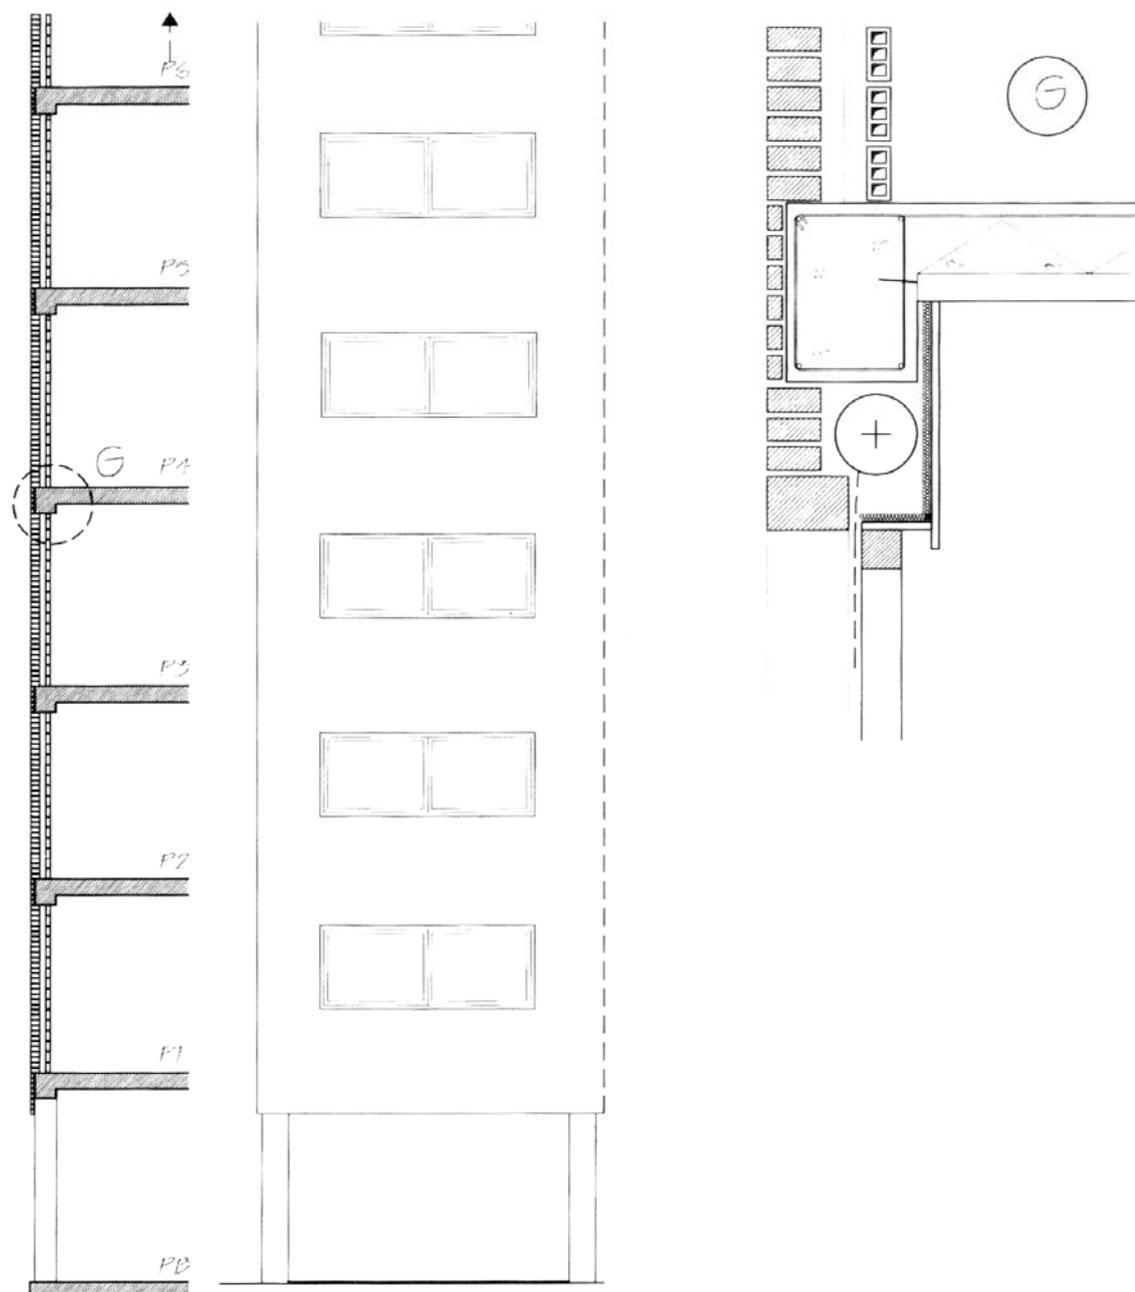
Años 70: Estructura de hormigón. Hoja exterior semivolada de ½' pie
